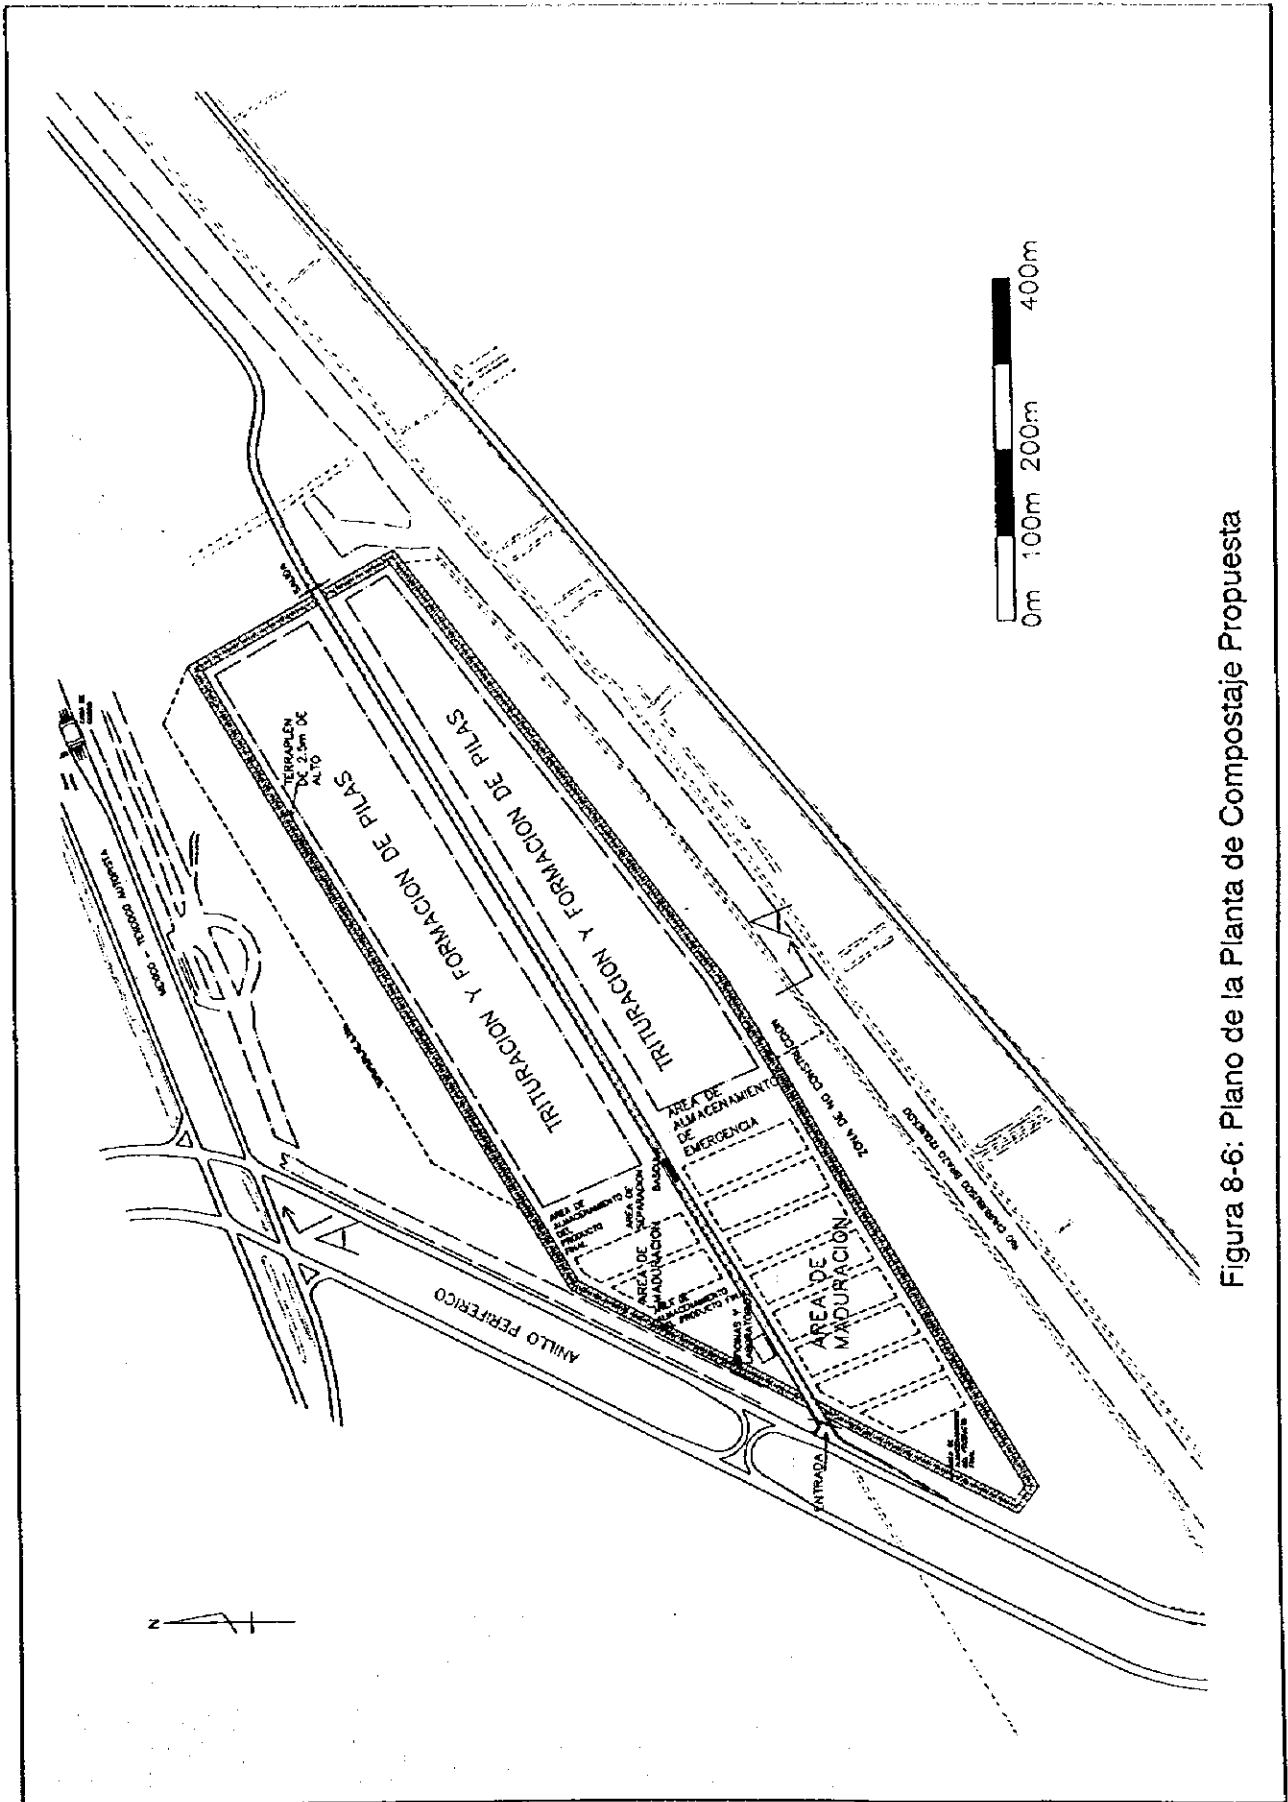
Plano de la Planta de Compostaje Propuesta
